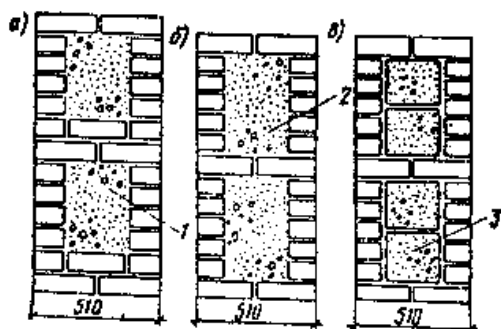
Облегченные кирпичные стены: а – с засыпкой шлаком; б – с заполнением легким бетоном; в – с термовкладышами; 1 – засыпка; 2 – легкий бетон; 3 – термовкладыш.
